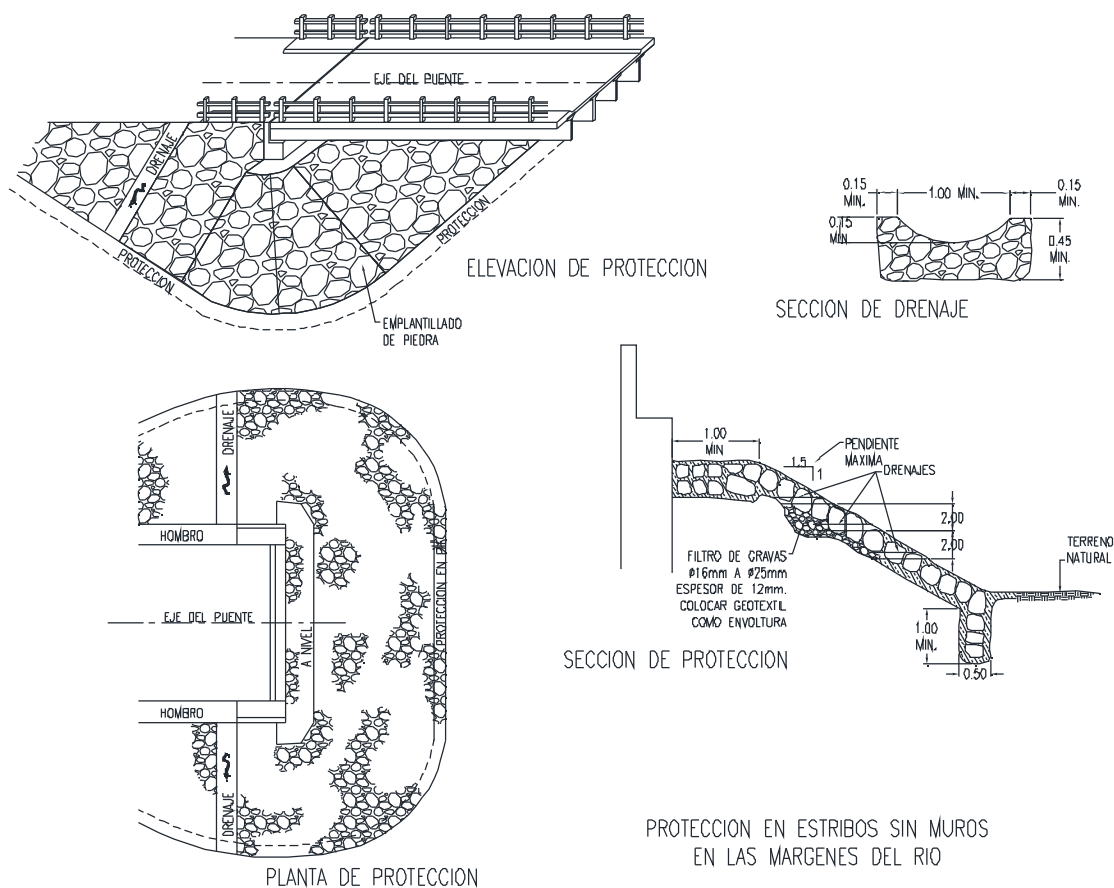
Protección para estribos sin muros en las márgenes del río, con emplantillado de piedra. (SPOP, 2014)
